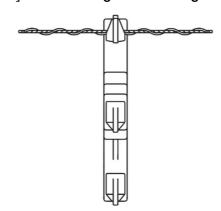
Amarrações e ancoragens – Mensageiro – Espaçadores – Com Iaço pré-formado metálico
